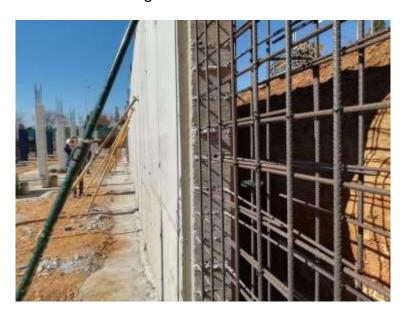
Muros de hormigón armado para sótano. Tomada de (Tronch, 2022).
